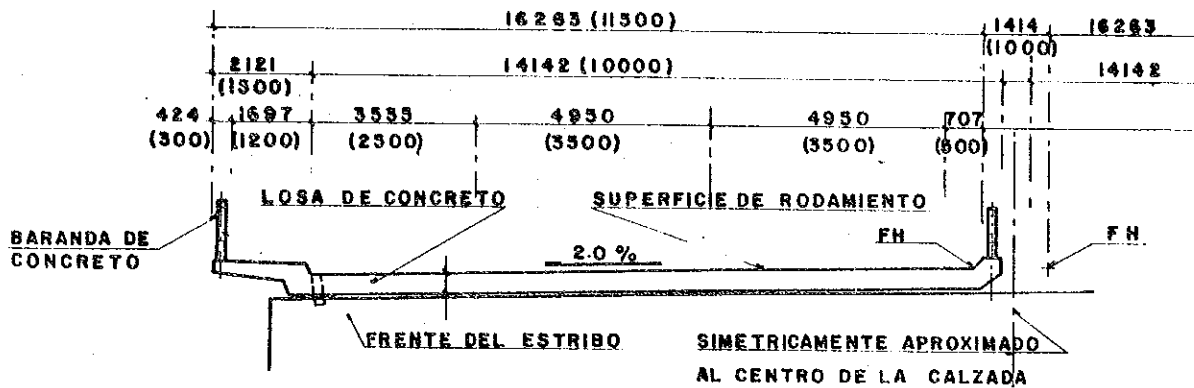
Puente La Morita, Losa de Concreto Reforzado
